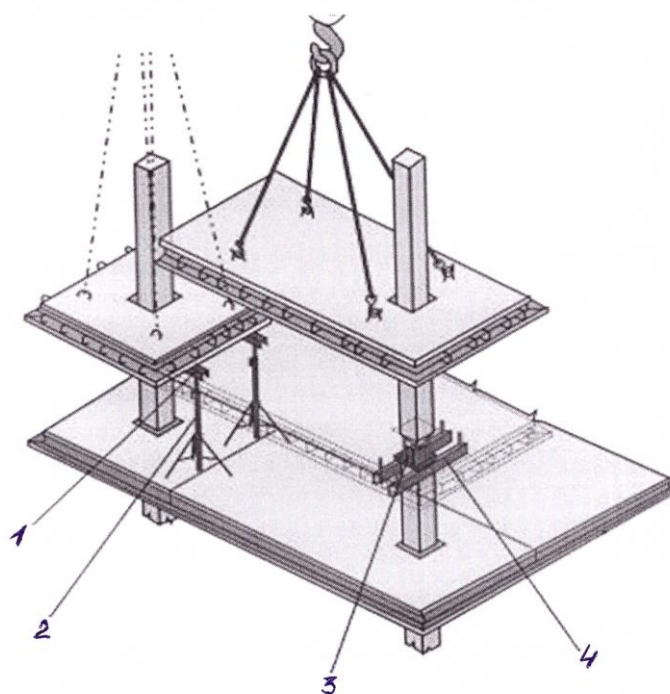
Монтаж міжколонної плити: 1 – опора; 2 – стійка; 3 – кондуктор установки надколонної плити; 4 – збірний опорний столик на чотири точки опори.
